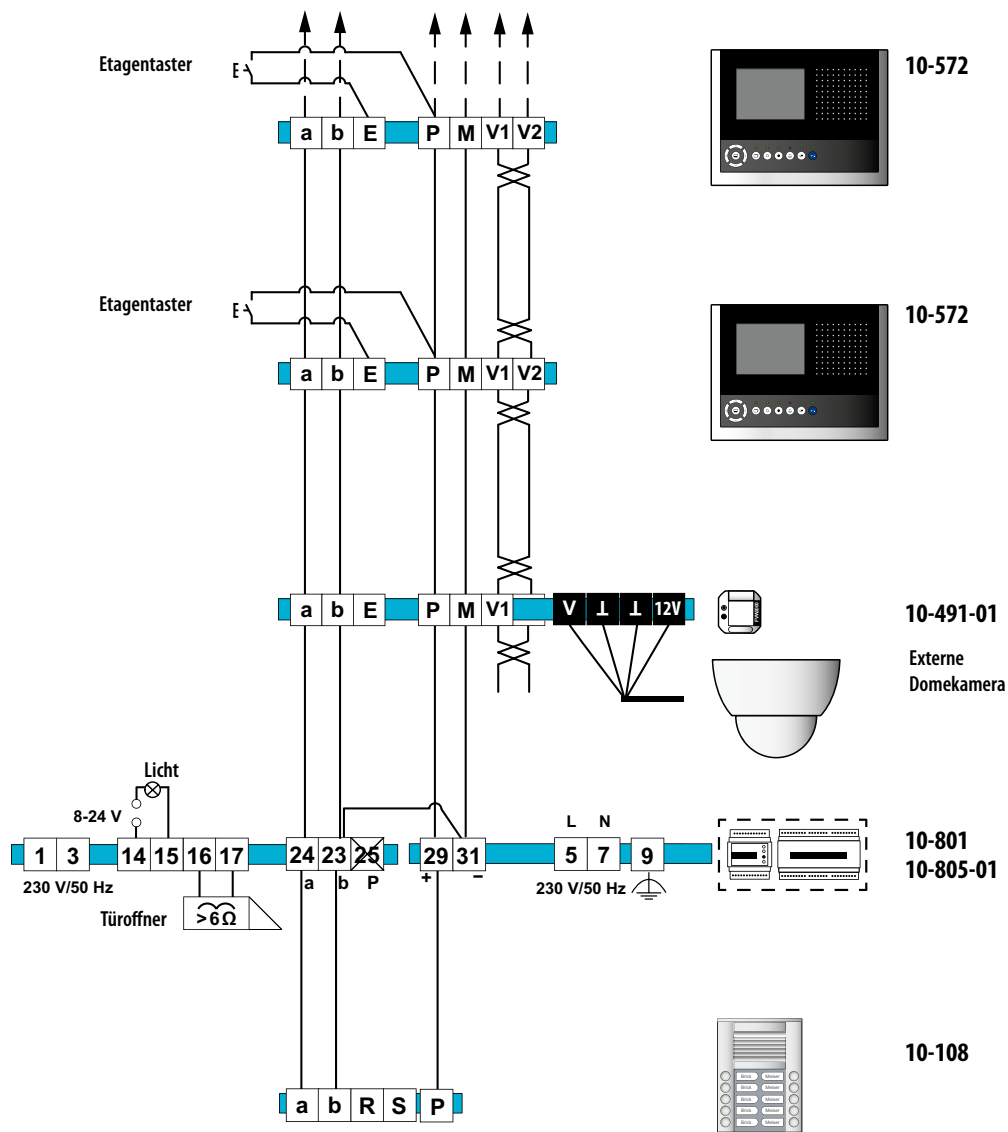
Schaltungsbeispiel 6-Drahttechnik
